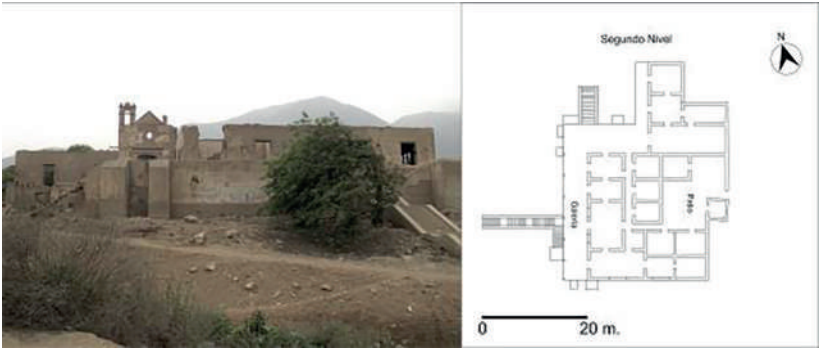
Foto y plano de planta del segundo nivel de la casa hacienda Caballero.
